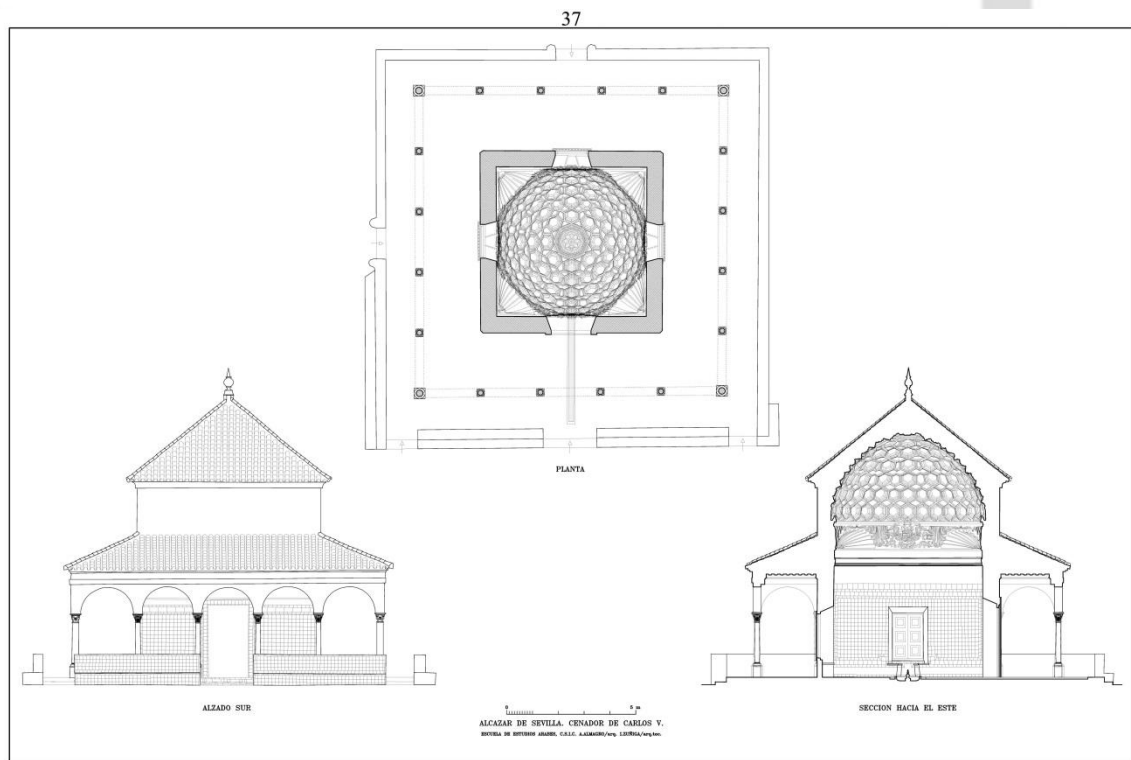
Documentación en formato pdf, aportada por la Escuela de Estudios Árabes del CSIS. Arquitecto Antonio Almagro Gorbea. Planimetría del Alcázar de Sevilla. Pág. 37
